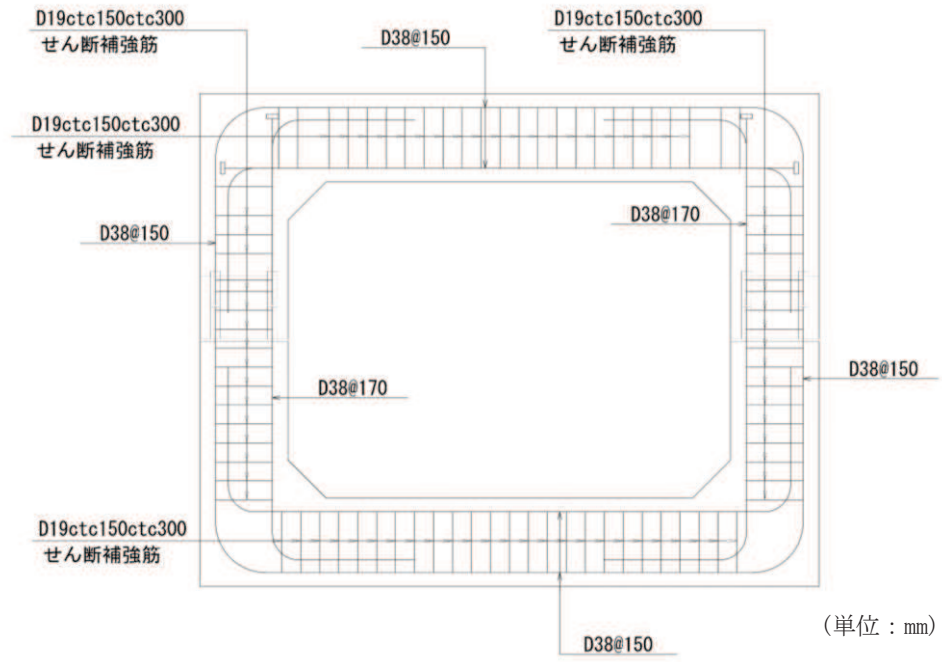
北側排水路の概略配筋図 (A-A 断面, B-B 断面共通)
